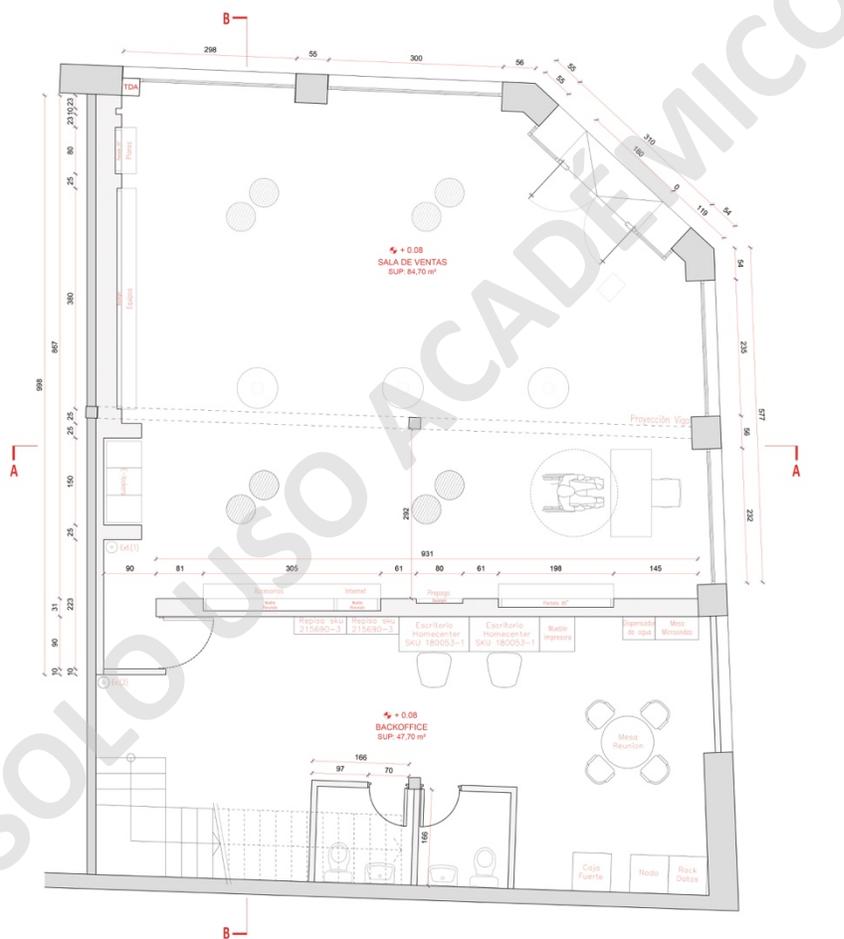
Sucursal Talca 8 Oriente - Planta Arquitectura.
